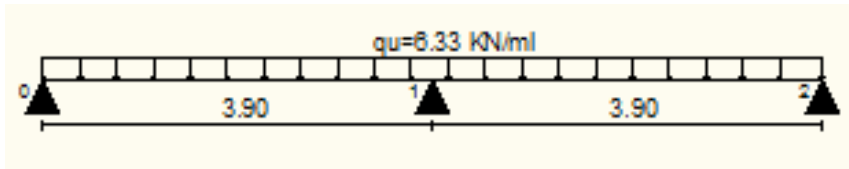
schéma statique de la poutrelle type 1 à l'ELU
